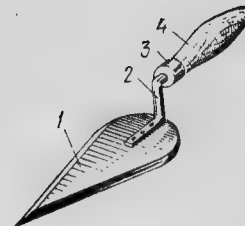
1 — полотно; 2 — колено; 3 — колпачок; 4 — ручка
